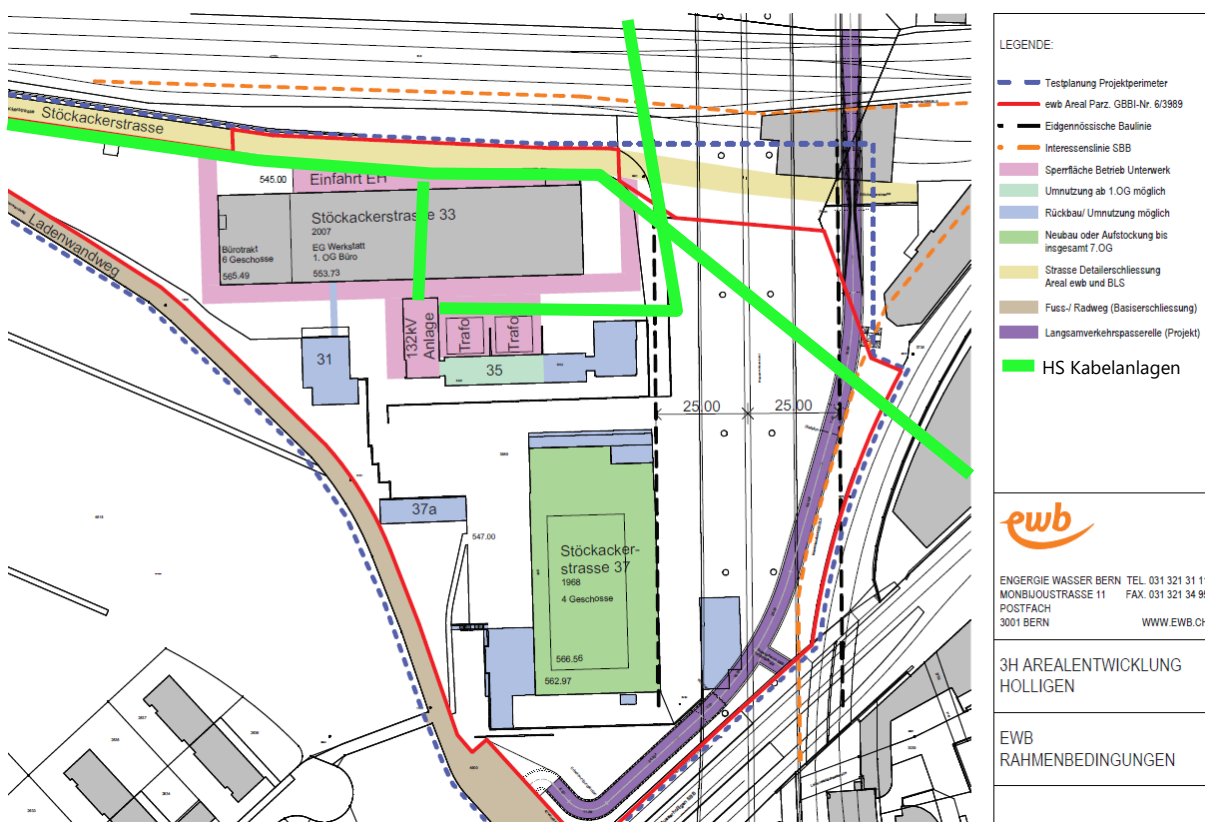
Ausschnitt Plan EWB Rahmenbedingungen mit Trafostandorten und Sperrflächen für Betrieb Unterwerk (rosa Fläche). (Quelle: ewb, 18.05.2015)
